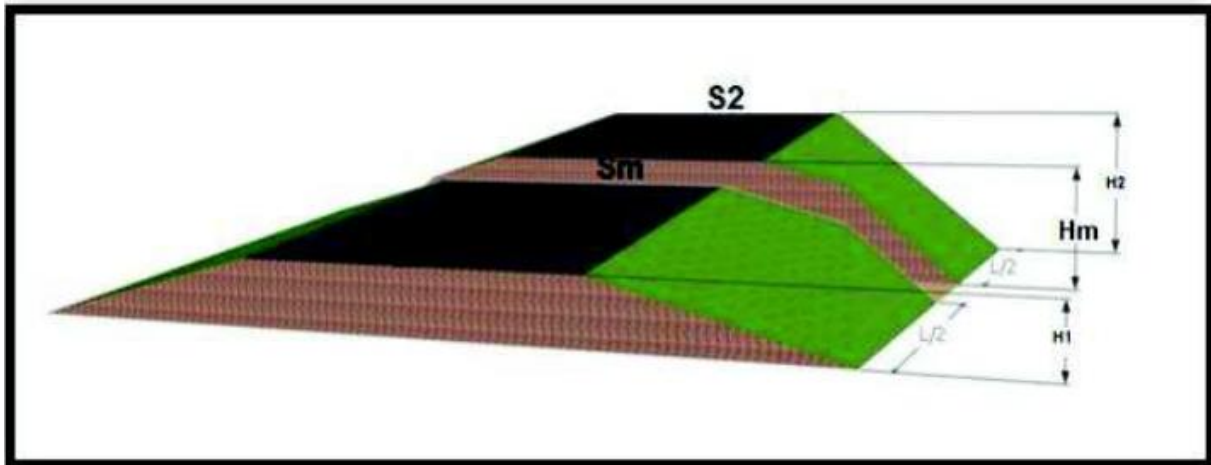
Les sections des profils en travers d'un tracé donné
